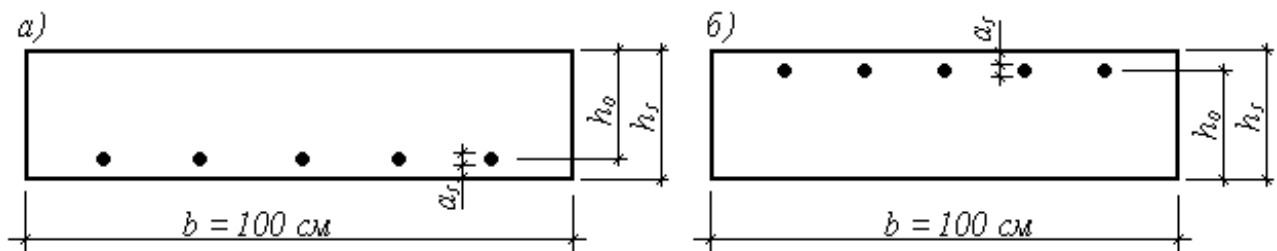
Розрахункові перерізи плити: а) на опори; б) в прольоті
